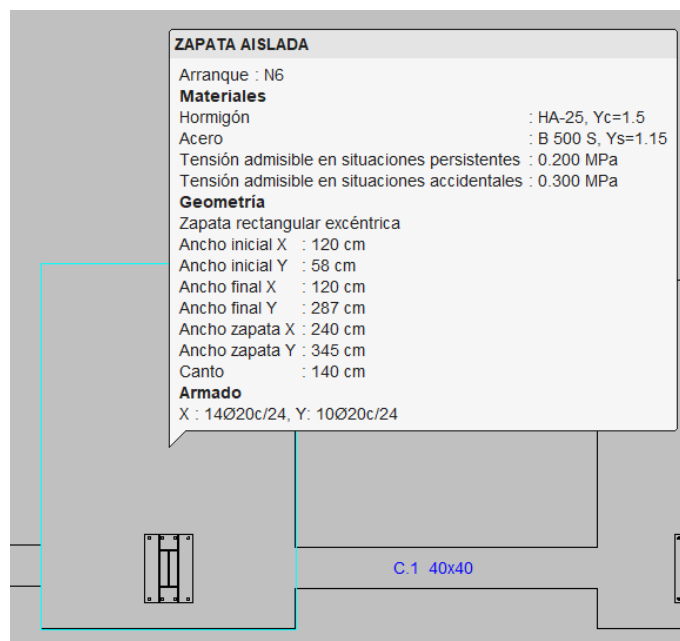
Dimensiones y características de la zapata medianera rectangular excéntrica
